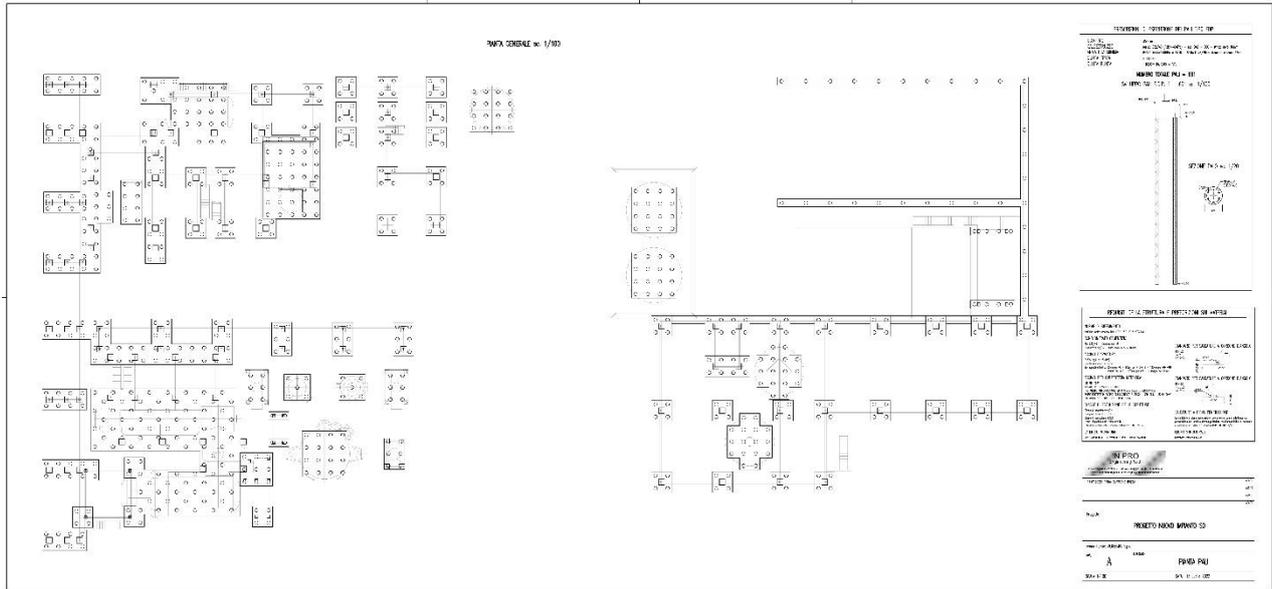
Schema del posizionamento delle aree impermeabili dei pali di fondazione – fuori scala
